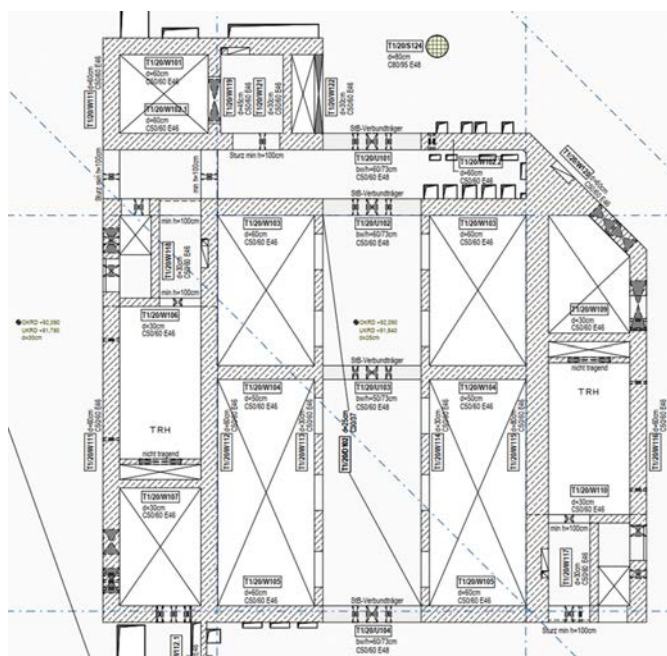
Grundriss Kern Regelgeschoss T1 (Quelle: ATW FOUR)
